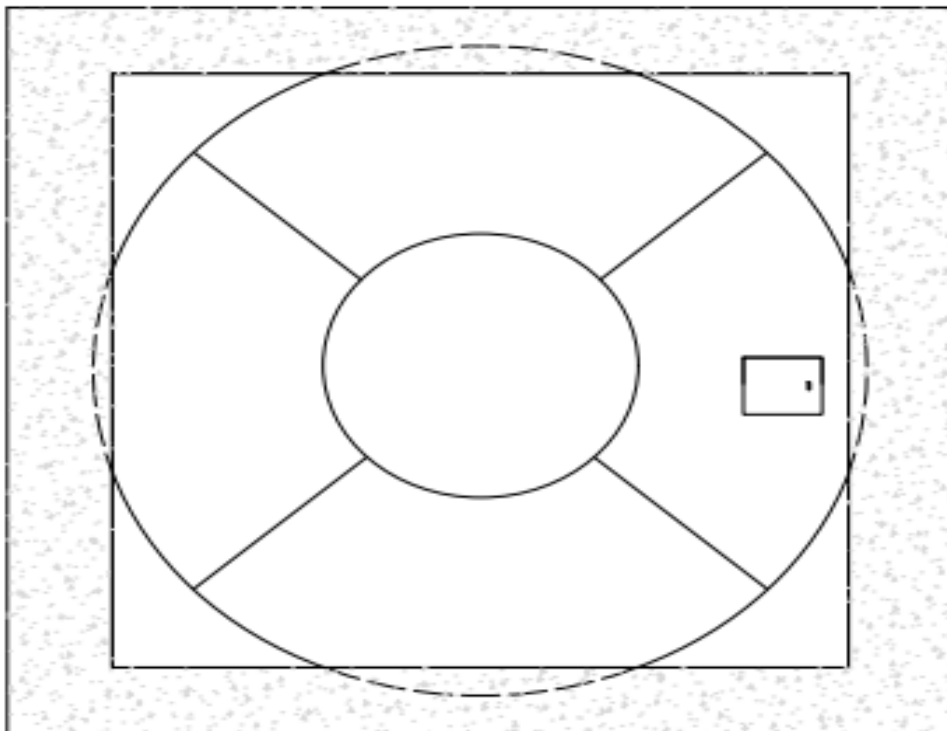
Planta baixa das cisternas e cortes -projeto executivo
